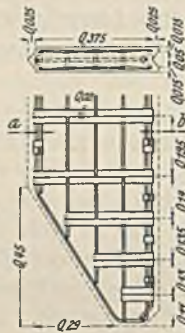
Eisenbetonspundbohle mit Querbewehrung aus Bandeisen.
